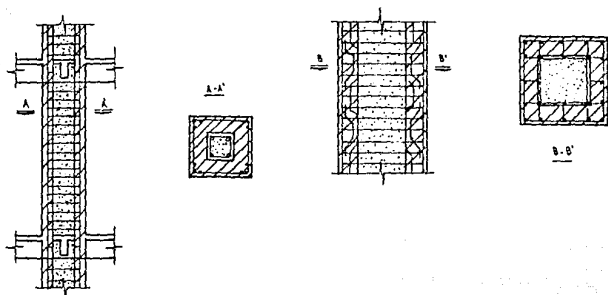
Encamisado de columnas con concreto reforzado.
